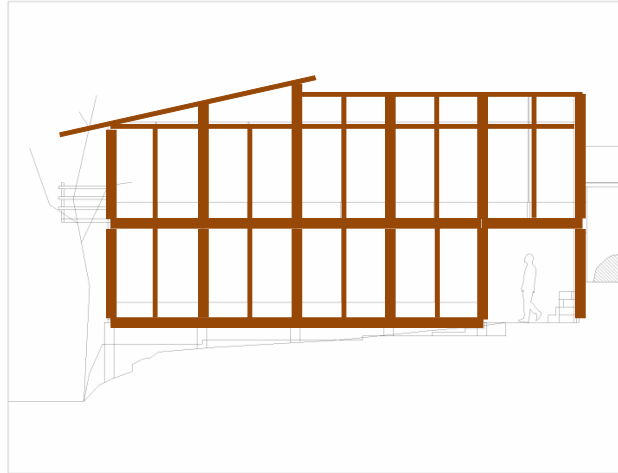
c-14 - Vista de la estructura de vigas de la fachada norte
